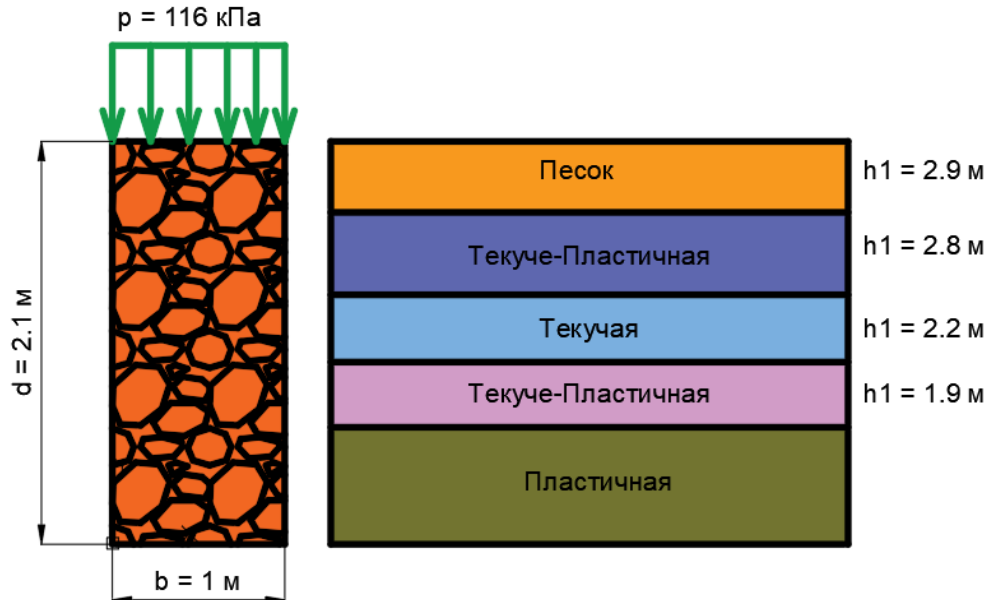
Размеры конструкции фундамента и давление на обрез фундамента принятые в расчете, и характерное инженерно-геологическое напластование опытной площадки.
